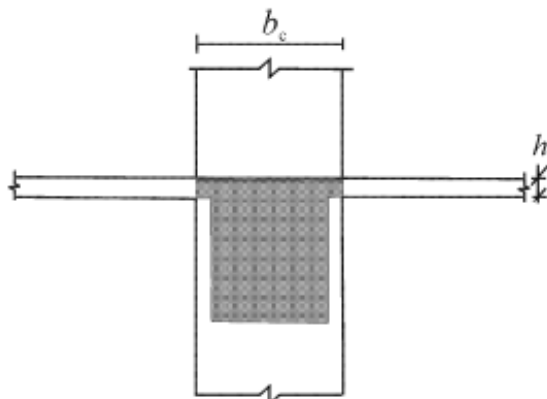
Largura efetiva do banço de uma viga ligada a um pilar exterior, sem viga transversal
